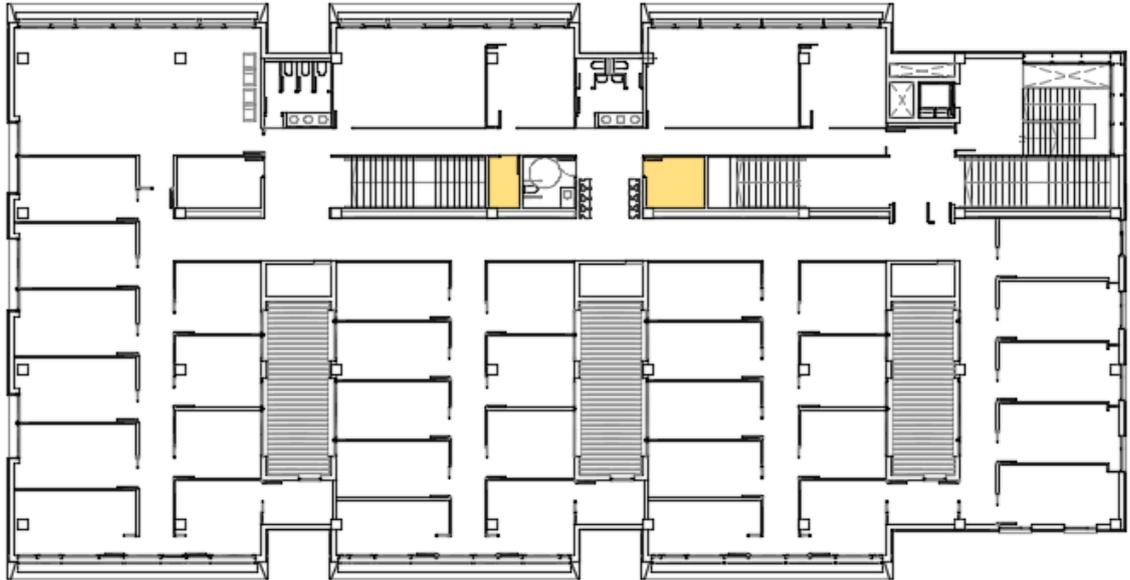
Situación de Almacenes en Planta Primera. Figura extraída del plano 53.
